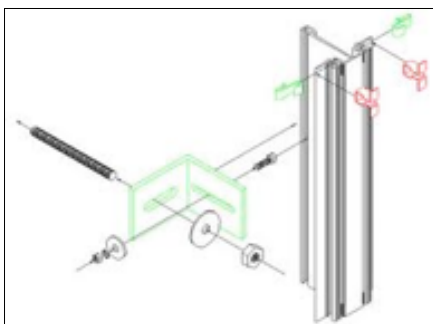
i 63 : Detall d'ancoratge fixat a la subestructura.
